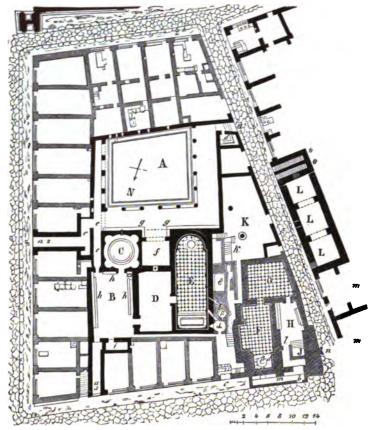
Plan der "fleinen Thermen" zu Pompeji. A dis B Männerbad; F dis I Stauenabteilung; a 1, 2, 3 Eingänge zum Männerbad; A innerer Hofraum; d Abtritt; o Kortidor; B Auskleidezimmer (Apodyterium); f Ezedra (Zimmer mit Ruhebänken); C taites Bad; D Tepidarium; E Caldarium; F Caldarium; G Tepidarium; H Apodyterium; I Srigidarium; K Hof; L Zisterne.
